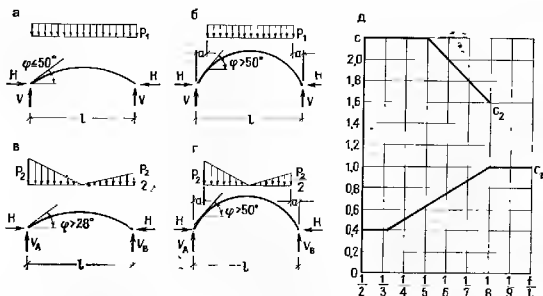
Снеговая нагрузка на сводчатое покрытие
